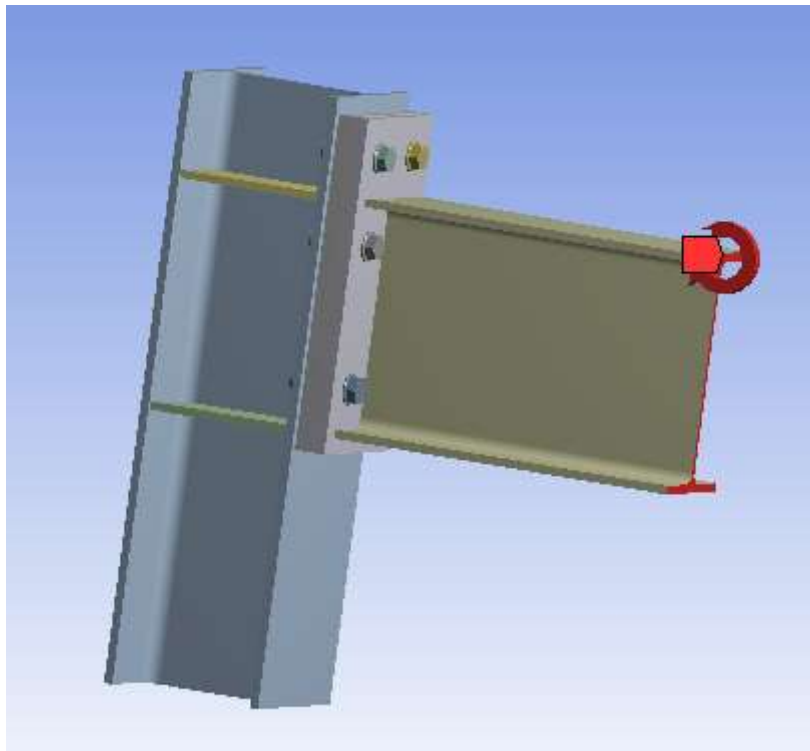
Esempio di carico flettente su un piano di collegamenti bullonati
